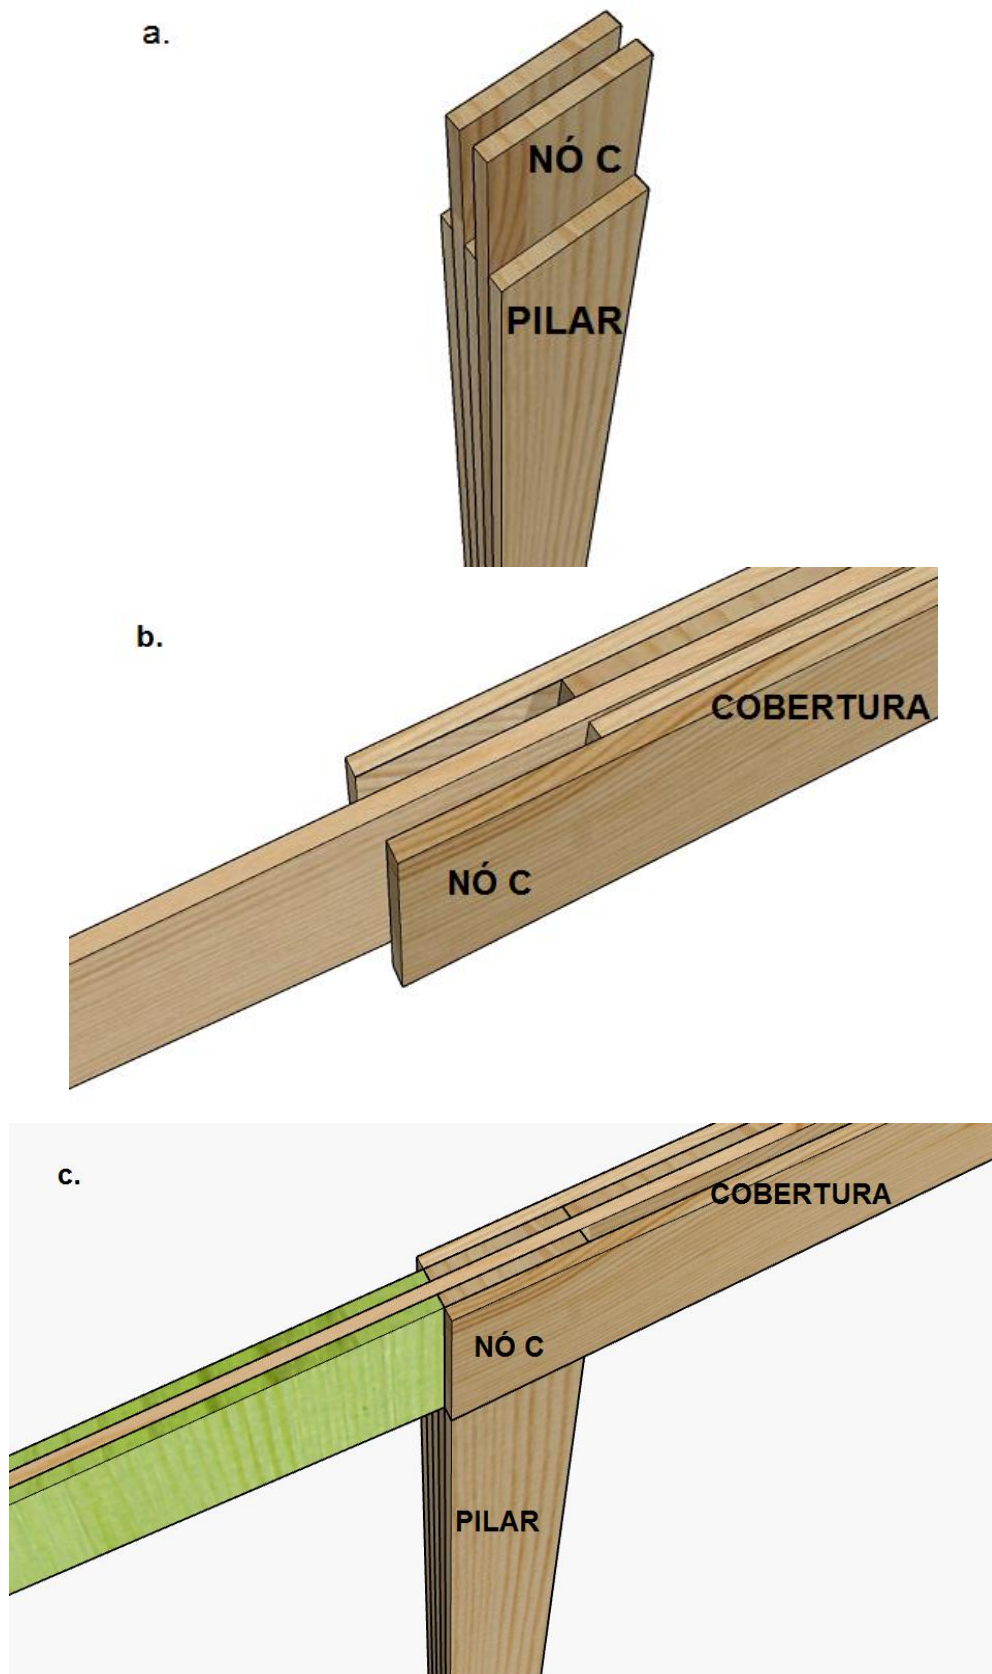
Detalhe da configuração do pilar (a), viga de cobertura (b) e transpasse das peças (c) para formar a ligação.
